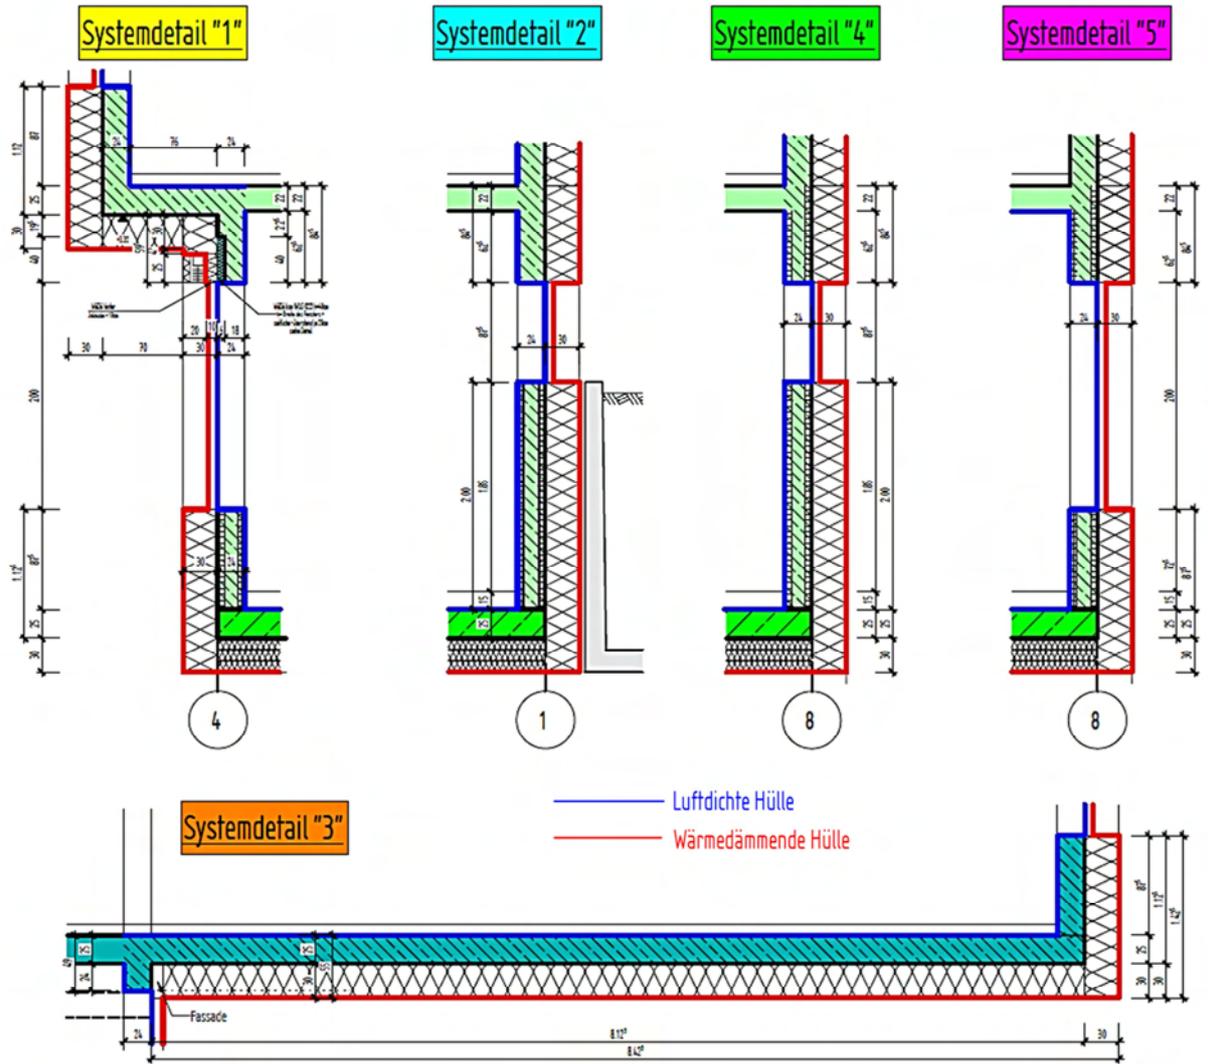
Grundriss Bodenplatte, Wärmebrückenerfassung
